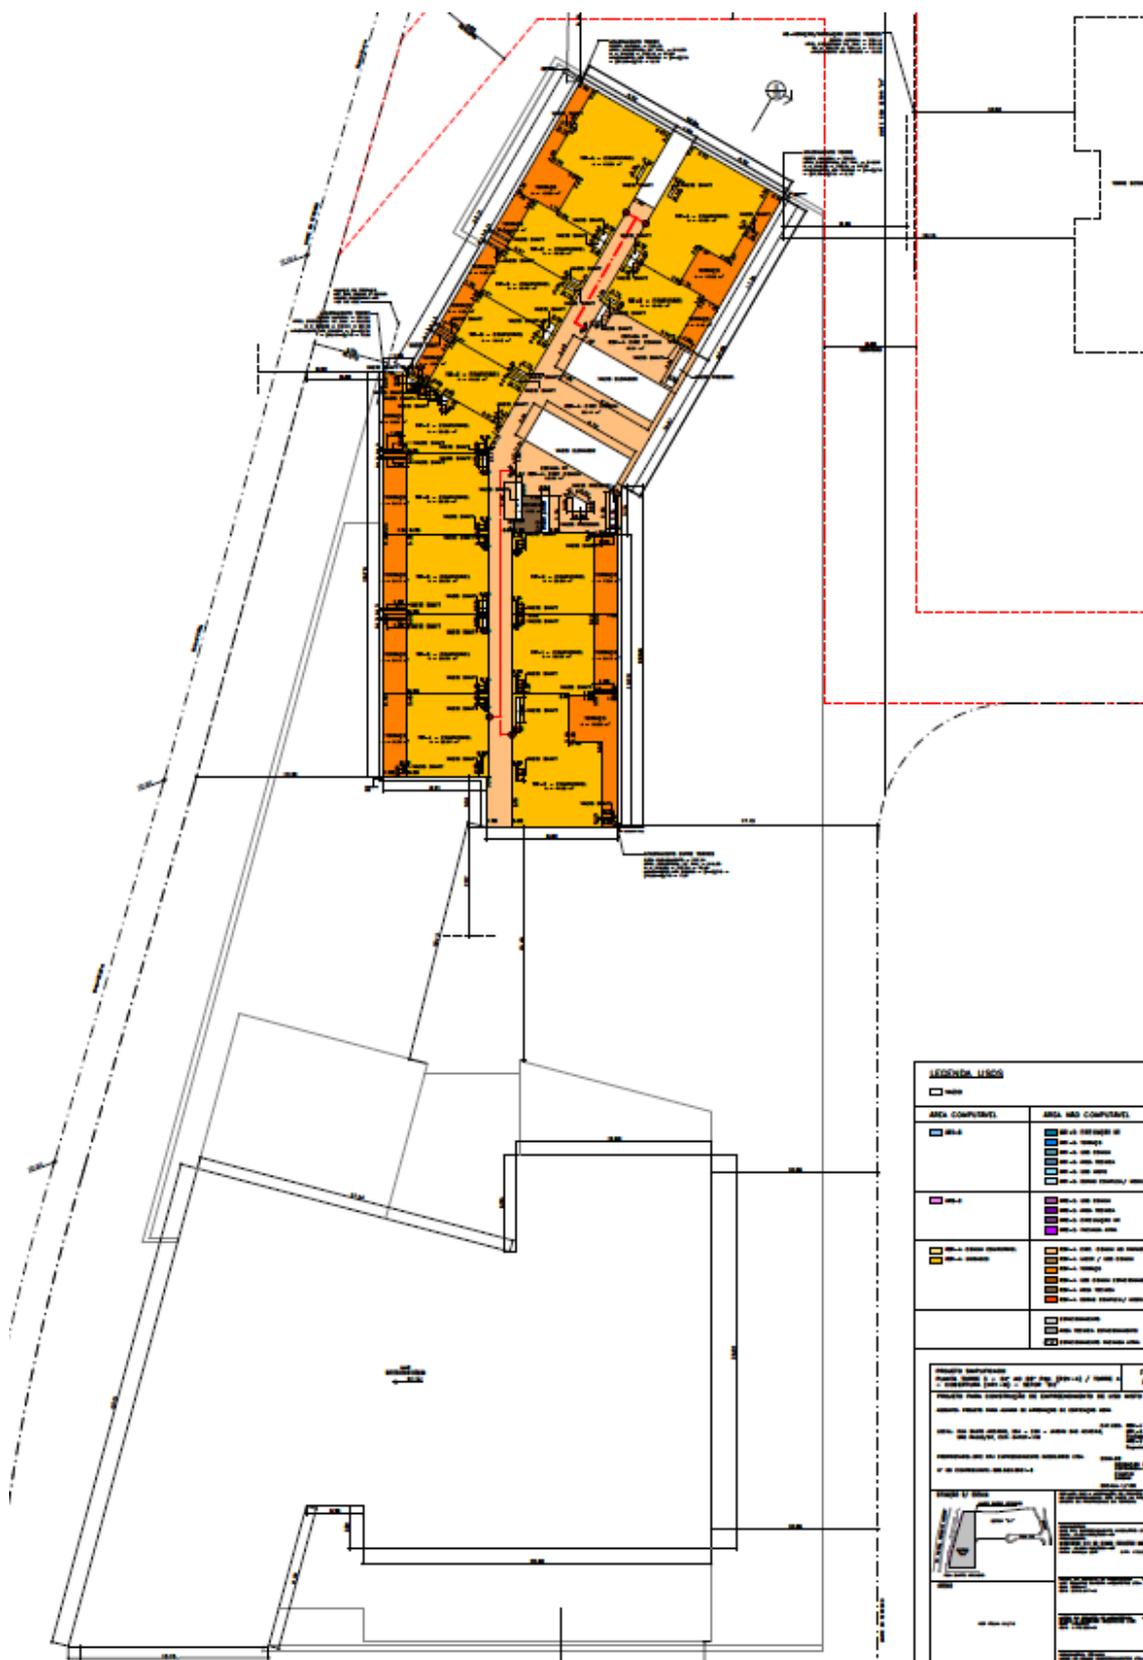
Torre 3 - 24<sup>o</sup> ao 28<sup>o</sup> pavimento. Torre 4 – cobertura. Setor B2.
